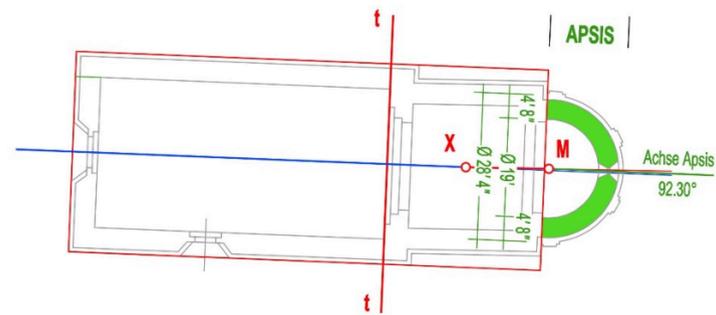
Pfarrkirche Schöngrabern, Grundriss Apsis
